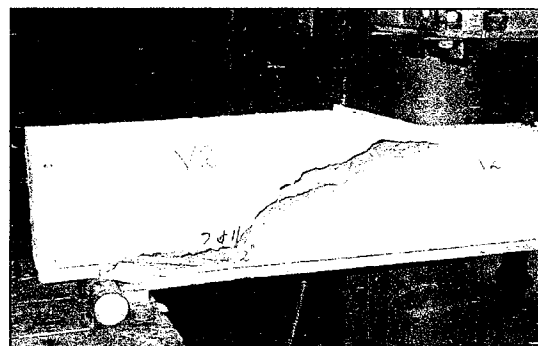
Fisuras de cortante en el alma con falla de adherencia.
